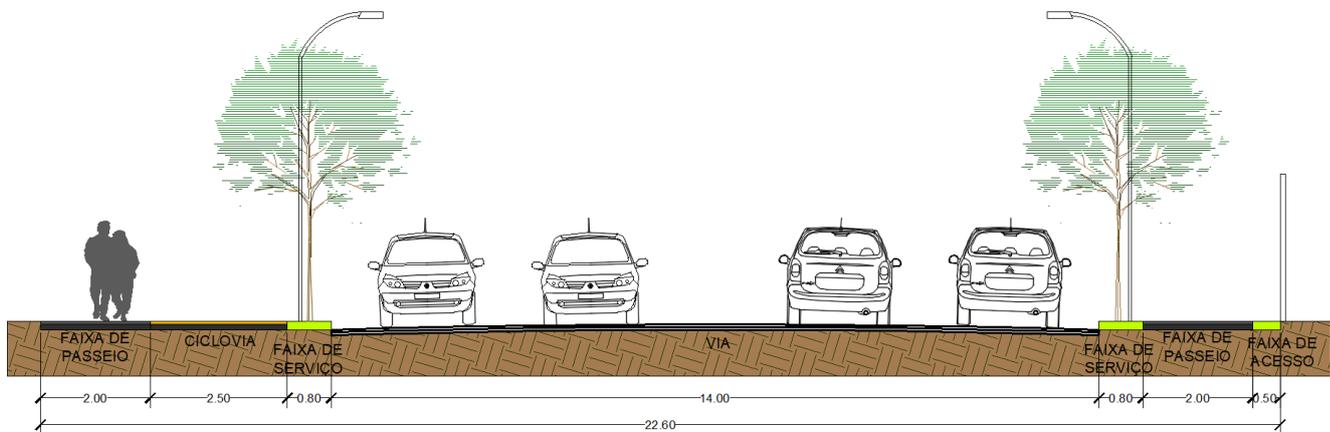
Perfil da Via de Circulação – Perfil 2 Paralelo a BR 070 (Fonte: Própria)
